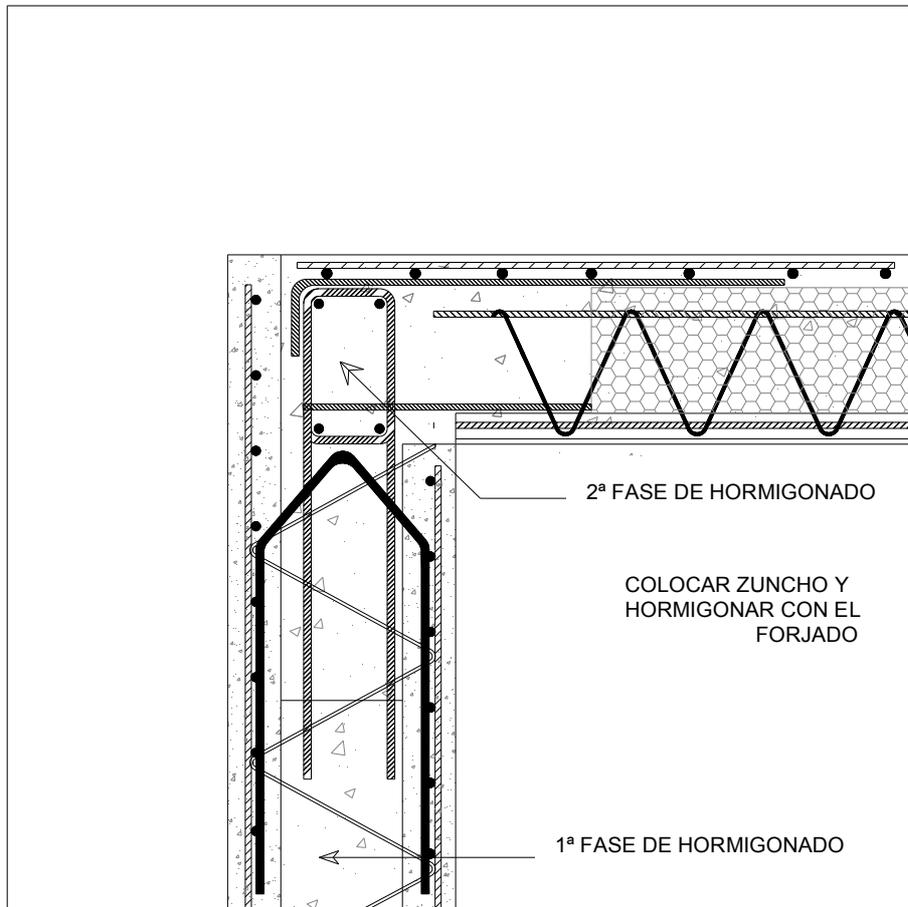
DETALLE DE UNIÓN CON MURO SUPERIOR – APOYO DIRECTO
